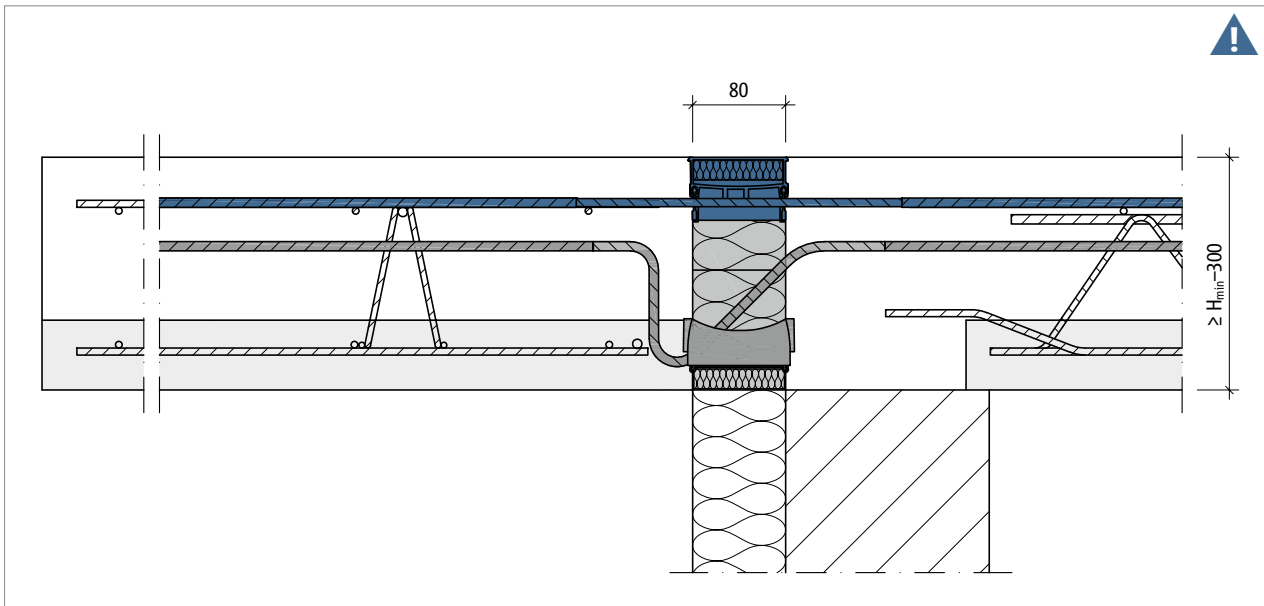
Schöck Isokorb® T Typ KL-F: Mehrteiliger Aufbau mit Oberteil, Zwischenteil (optional) und Unterteil. Hier: Oberteil eingefärbt.
